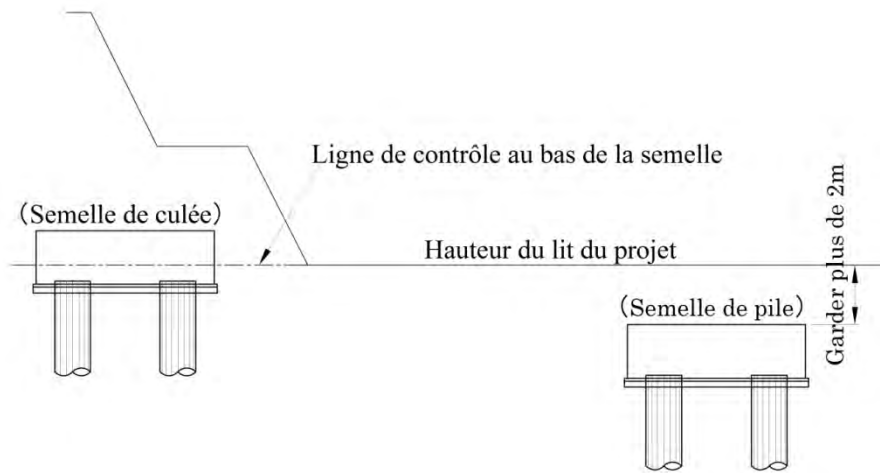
Emplacement du fond de fouille de la semelle
